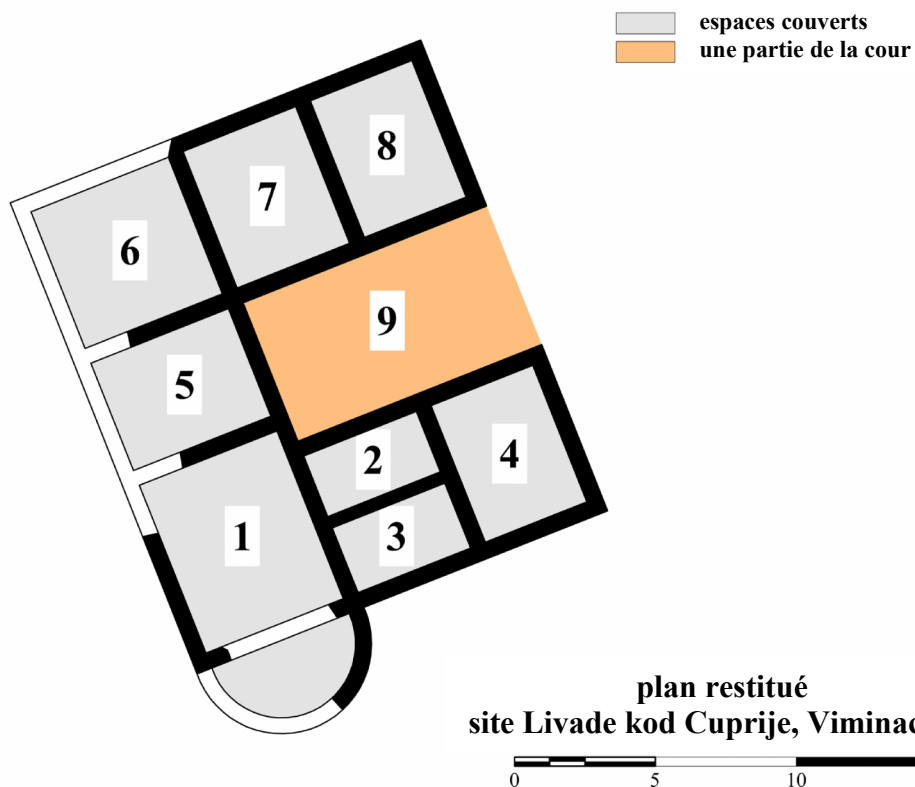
/6, Plan restitué, site de Livade kod Cuprije, Viminacium, A. M. d'après : M. Jovičić, 2011, 375, Fig.3
